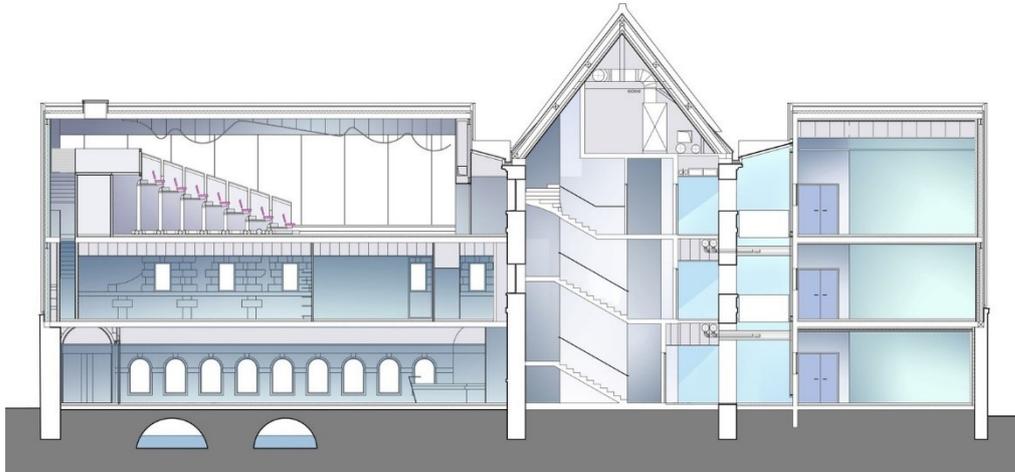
Corte esquemático. Fonte: Archdaily, 2013.
